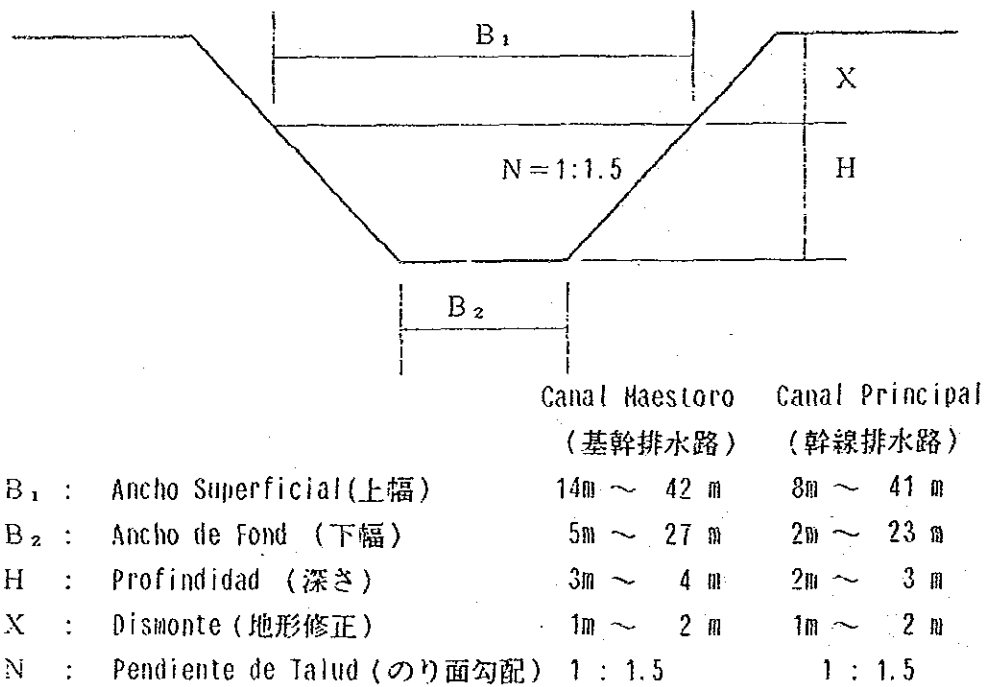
Sección del Canal de Drenaje (排水路の断面)
